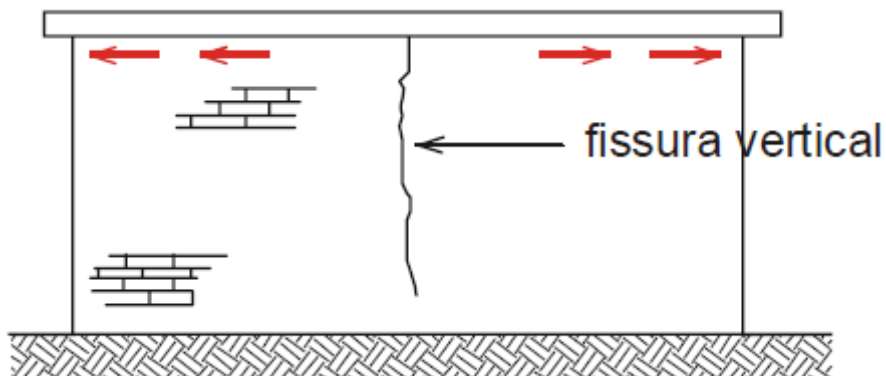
Fissura vertical oriunda das tensões de tração horizontal geradas pela movimentação da laje
